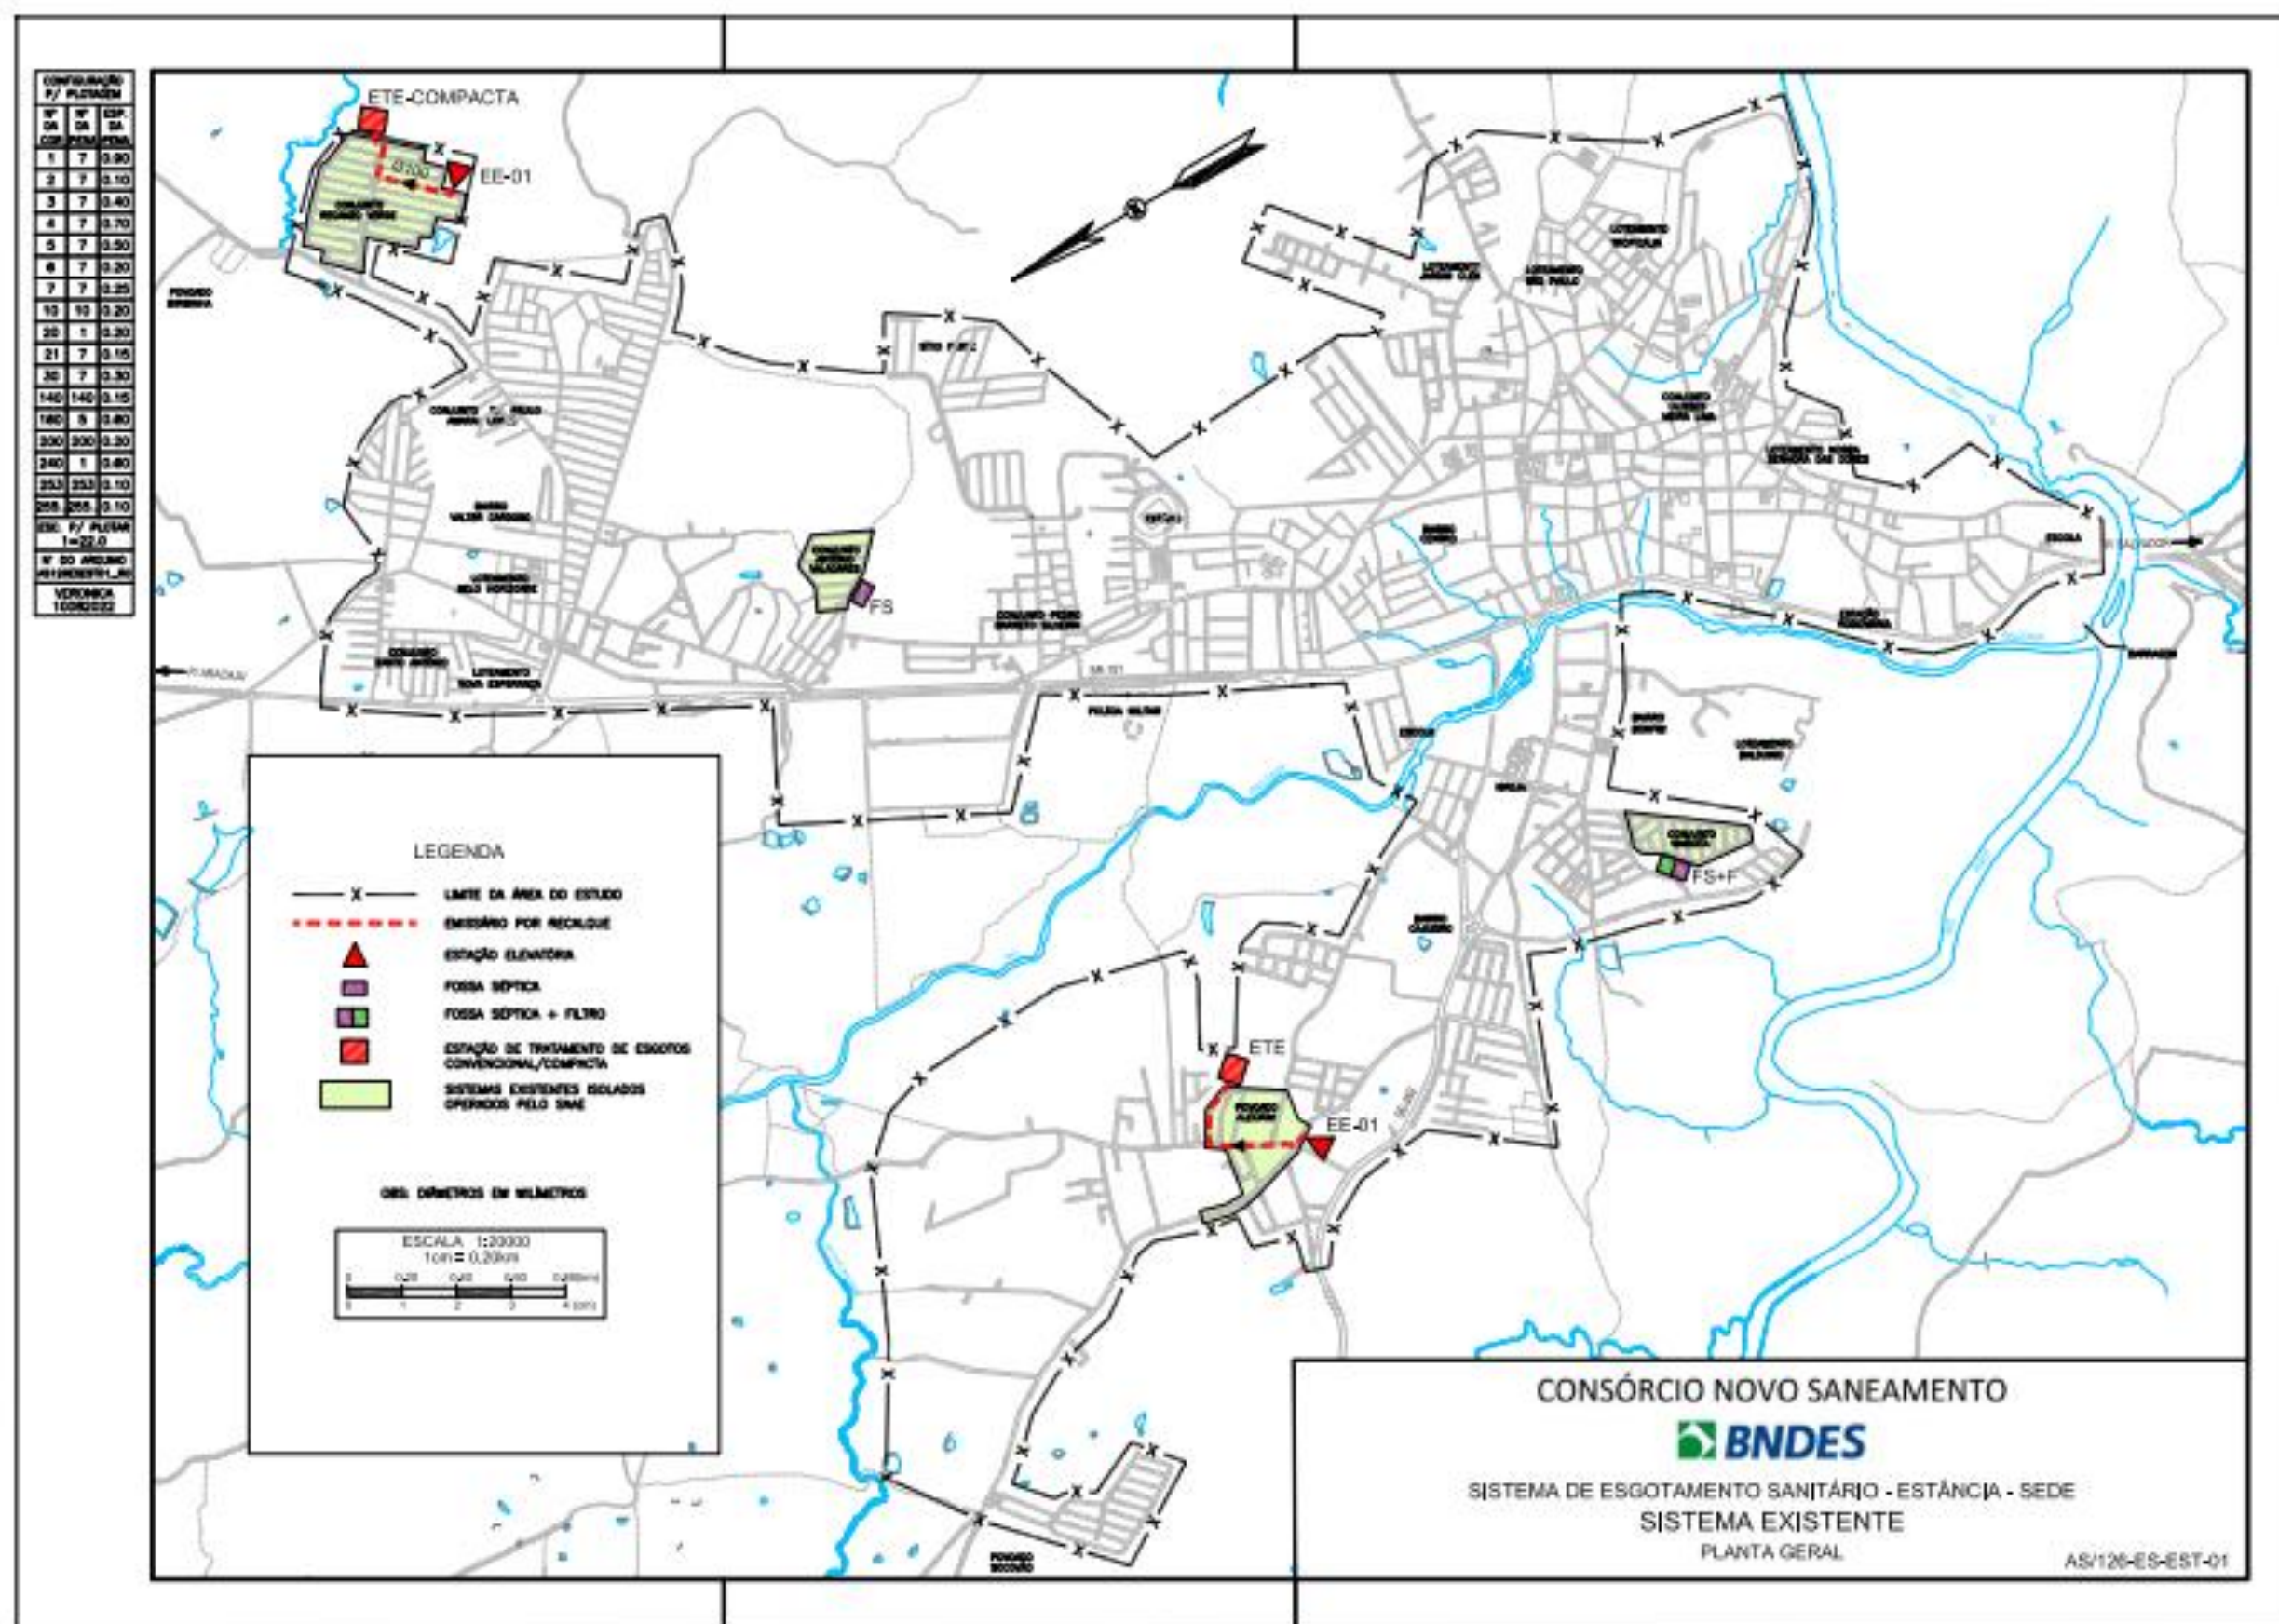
Planta do Sistema de Esgotamento Sanitário – ESTÂNCIA
